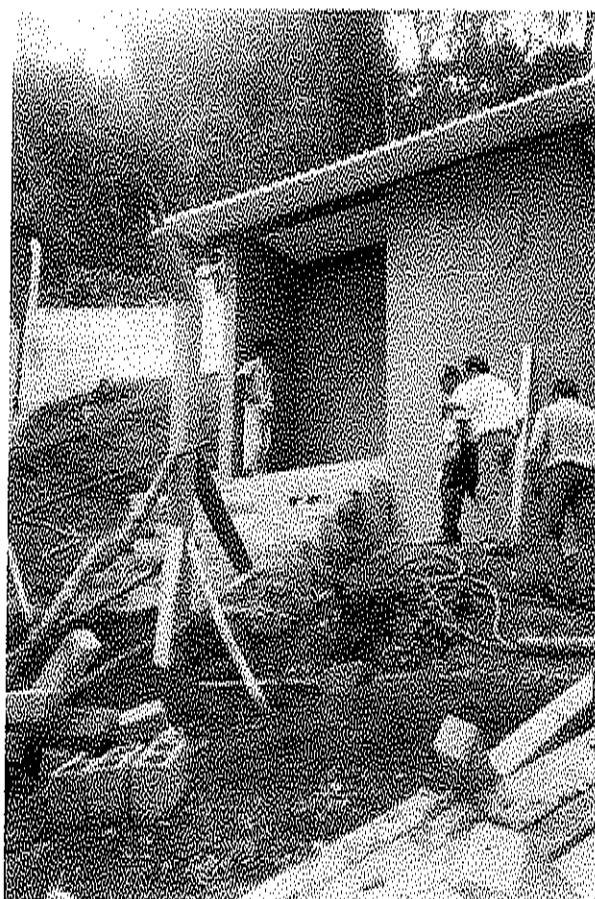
Fase avançada da construção do abrigo da ESAR.
